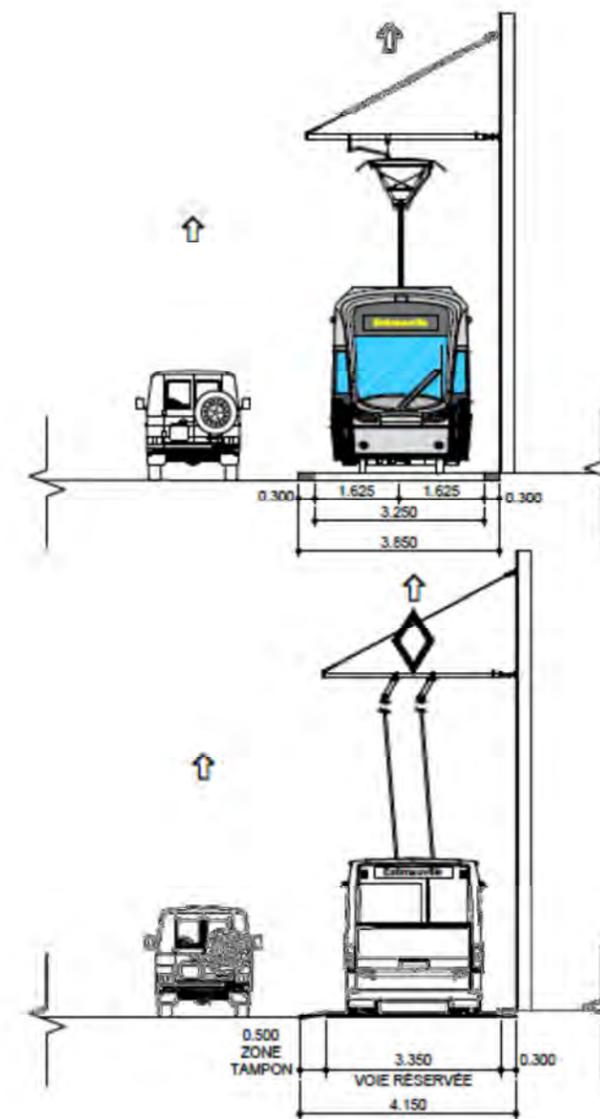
Coupe type 13 de 15 - SRB - Site espace restreint - Insertion bilatérale franchissable
